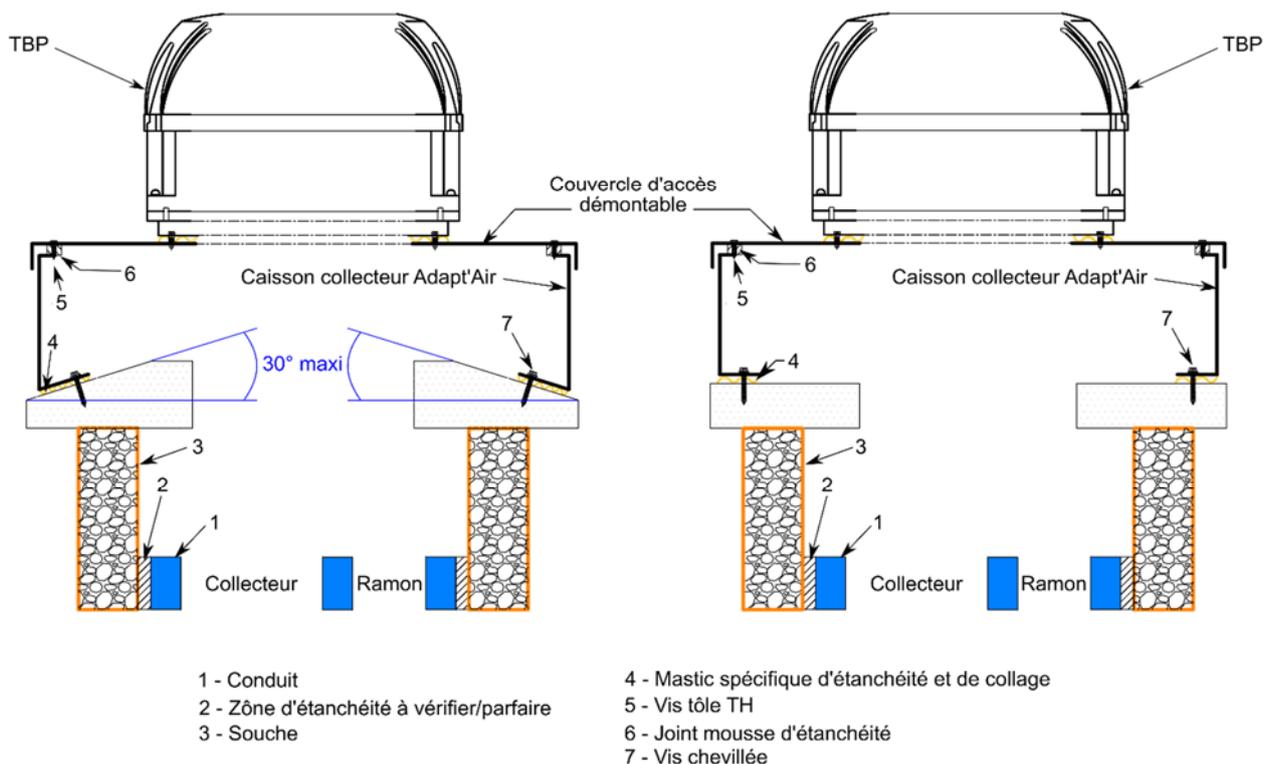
Coupe verticale d'un caisson collecteur Adapt'Air avec goutte d'eau sur dalle existante
